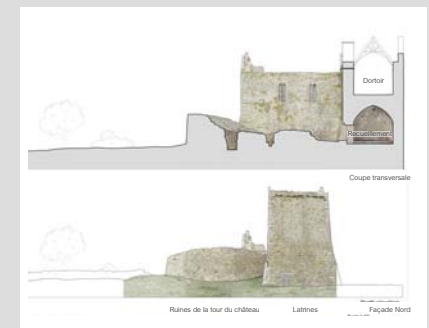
Coupe sur le dortoir et élévation d'une tour du château en ruines et des latrines
